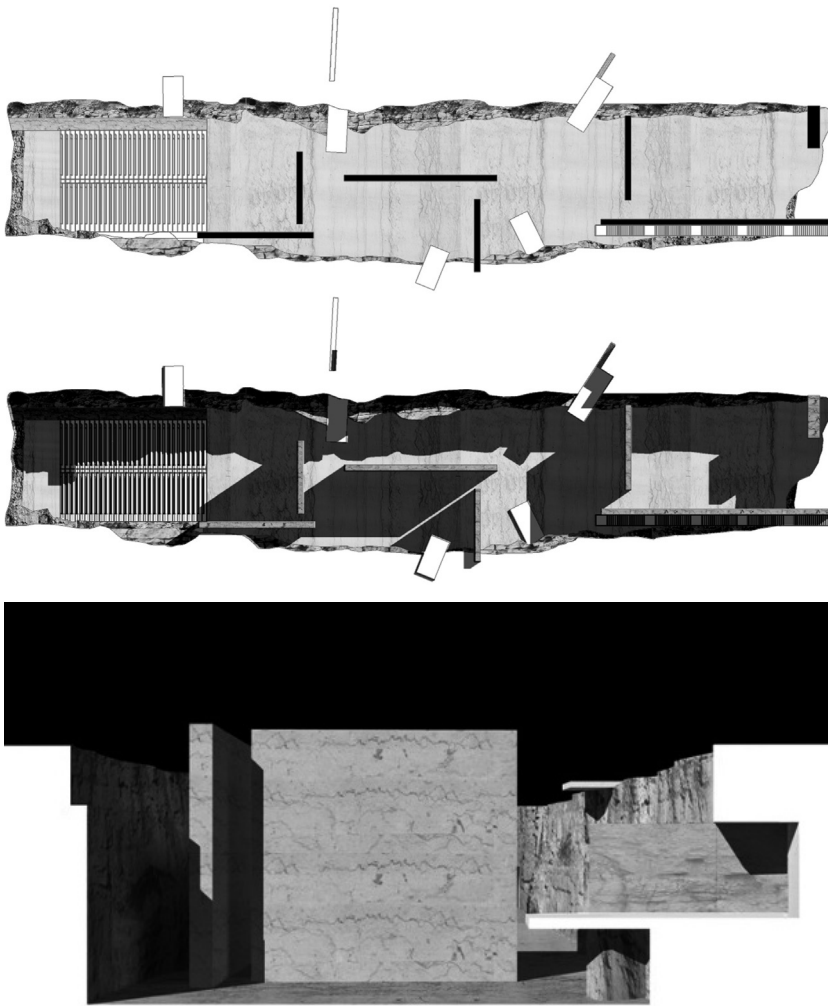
Progetto per la cava della Tufara a Trani: planimetria e planivolumetrico di progetto e sezione trasversale.
